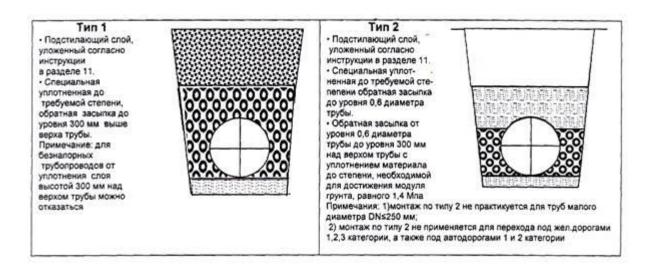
Типовая укладка труб (типовая траншея)
